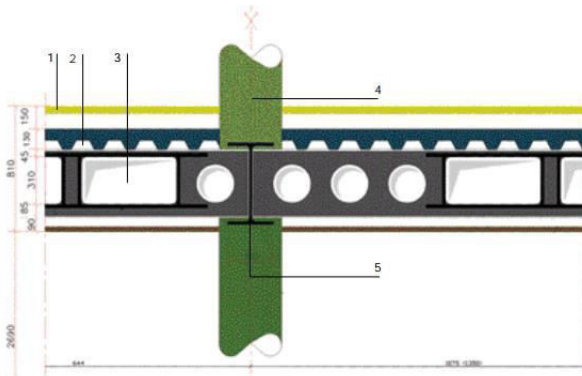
la jonction entre le poteau mixte et les poutres alvéolaires
